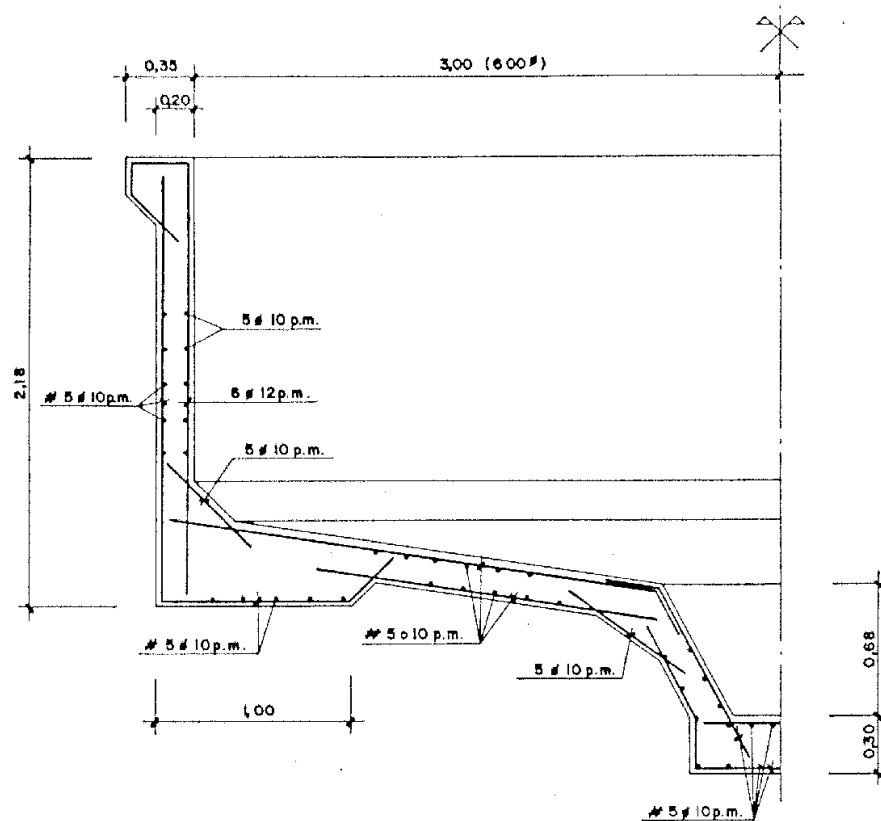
Armado requerido en la construcción del depósito tampón.
